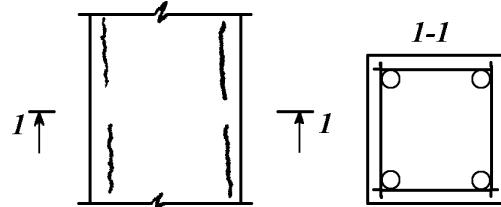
, а. Трещины вдоль продольной арматуры в сжатых элементах
